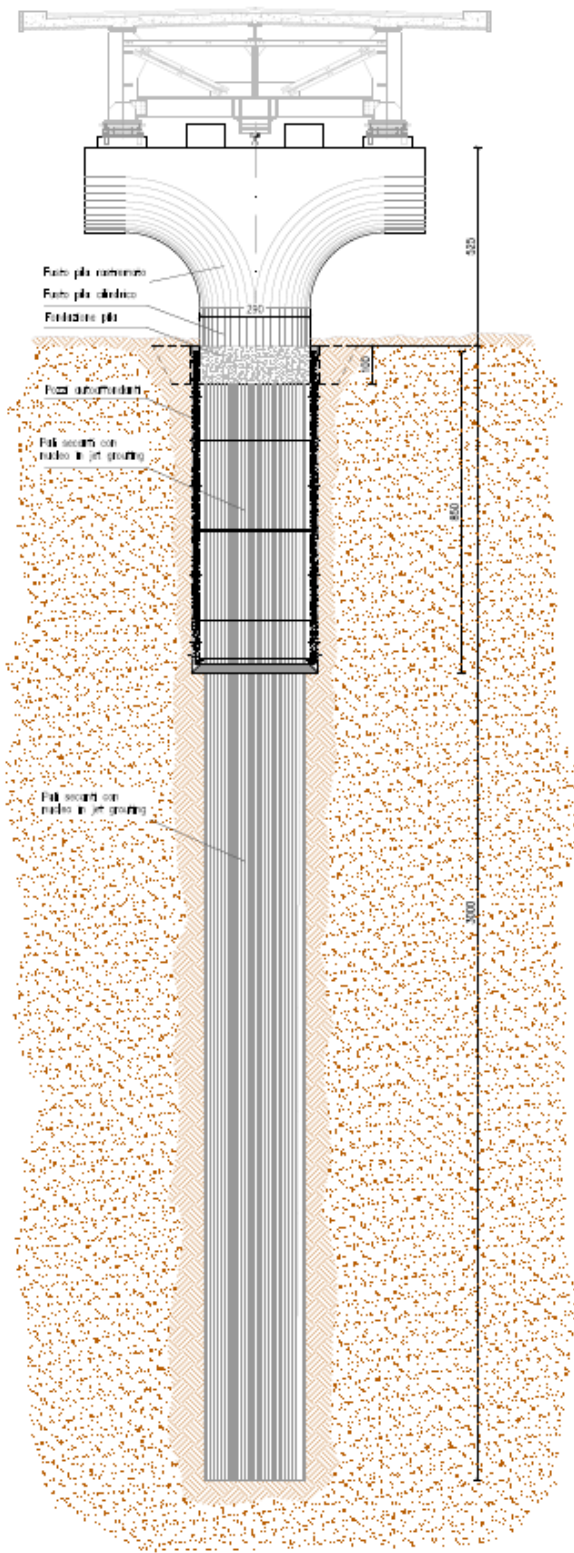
Vista d'insieme elevazione e fondazione delle pile
